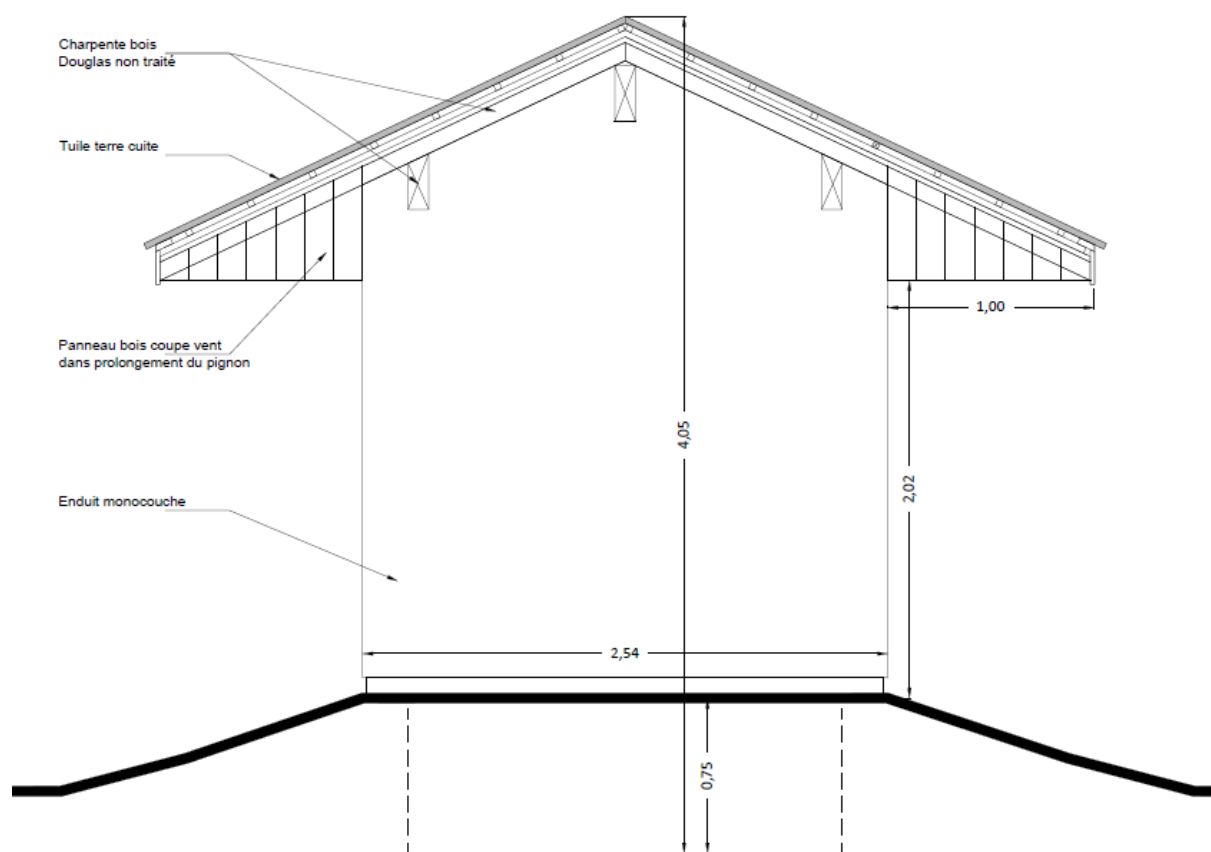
Plan du pignon sud et des panneaux bois coupe-vent dans le prolongement du pignon (Source : CD54)
